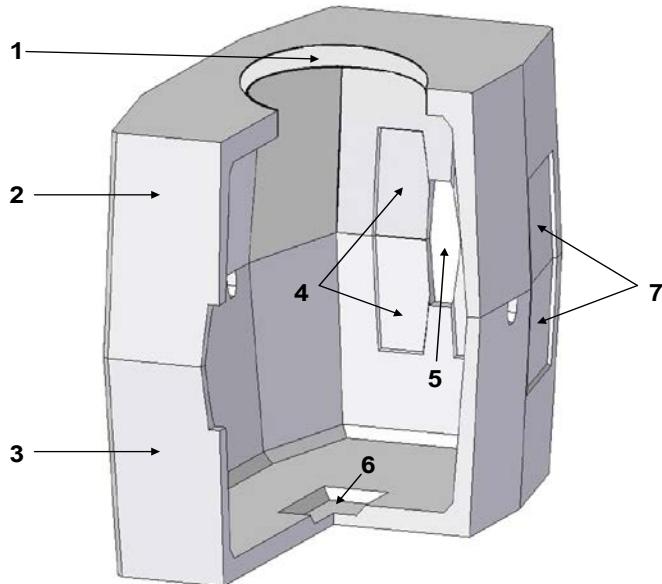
Колодец «ККСр-3-10» в сборе, внешний вид и детали элементов колодца:
